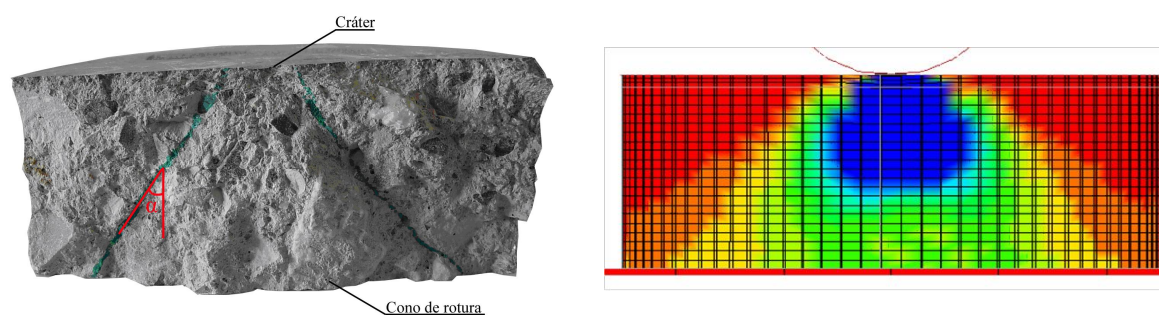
(a) Modo de rotura de las probetas de hormigón por impacto. (b) Distribución de las tensiones tras impacto.
